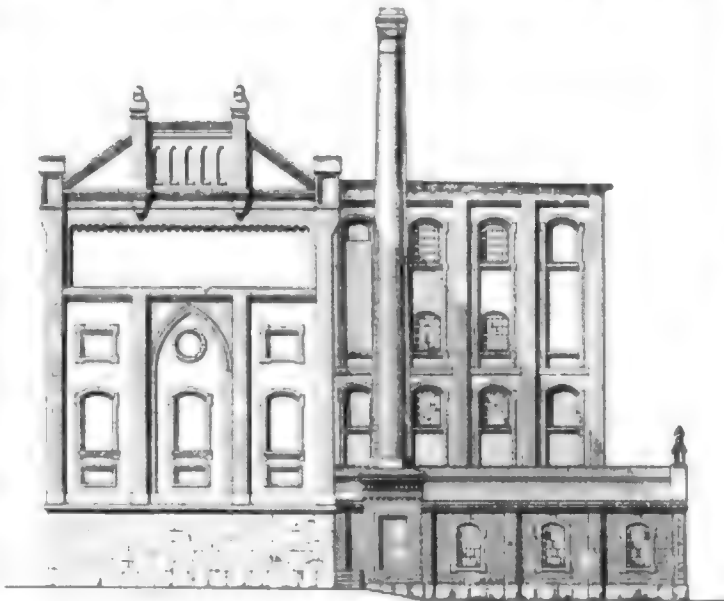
Fassaden der Thorner Dampfmühle Gerson & Co. in Thorn.
